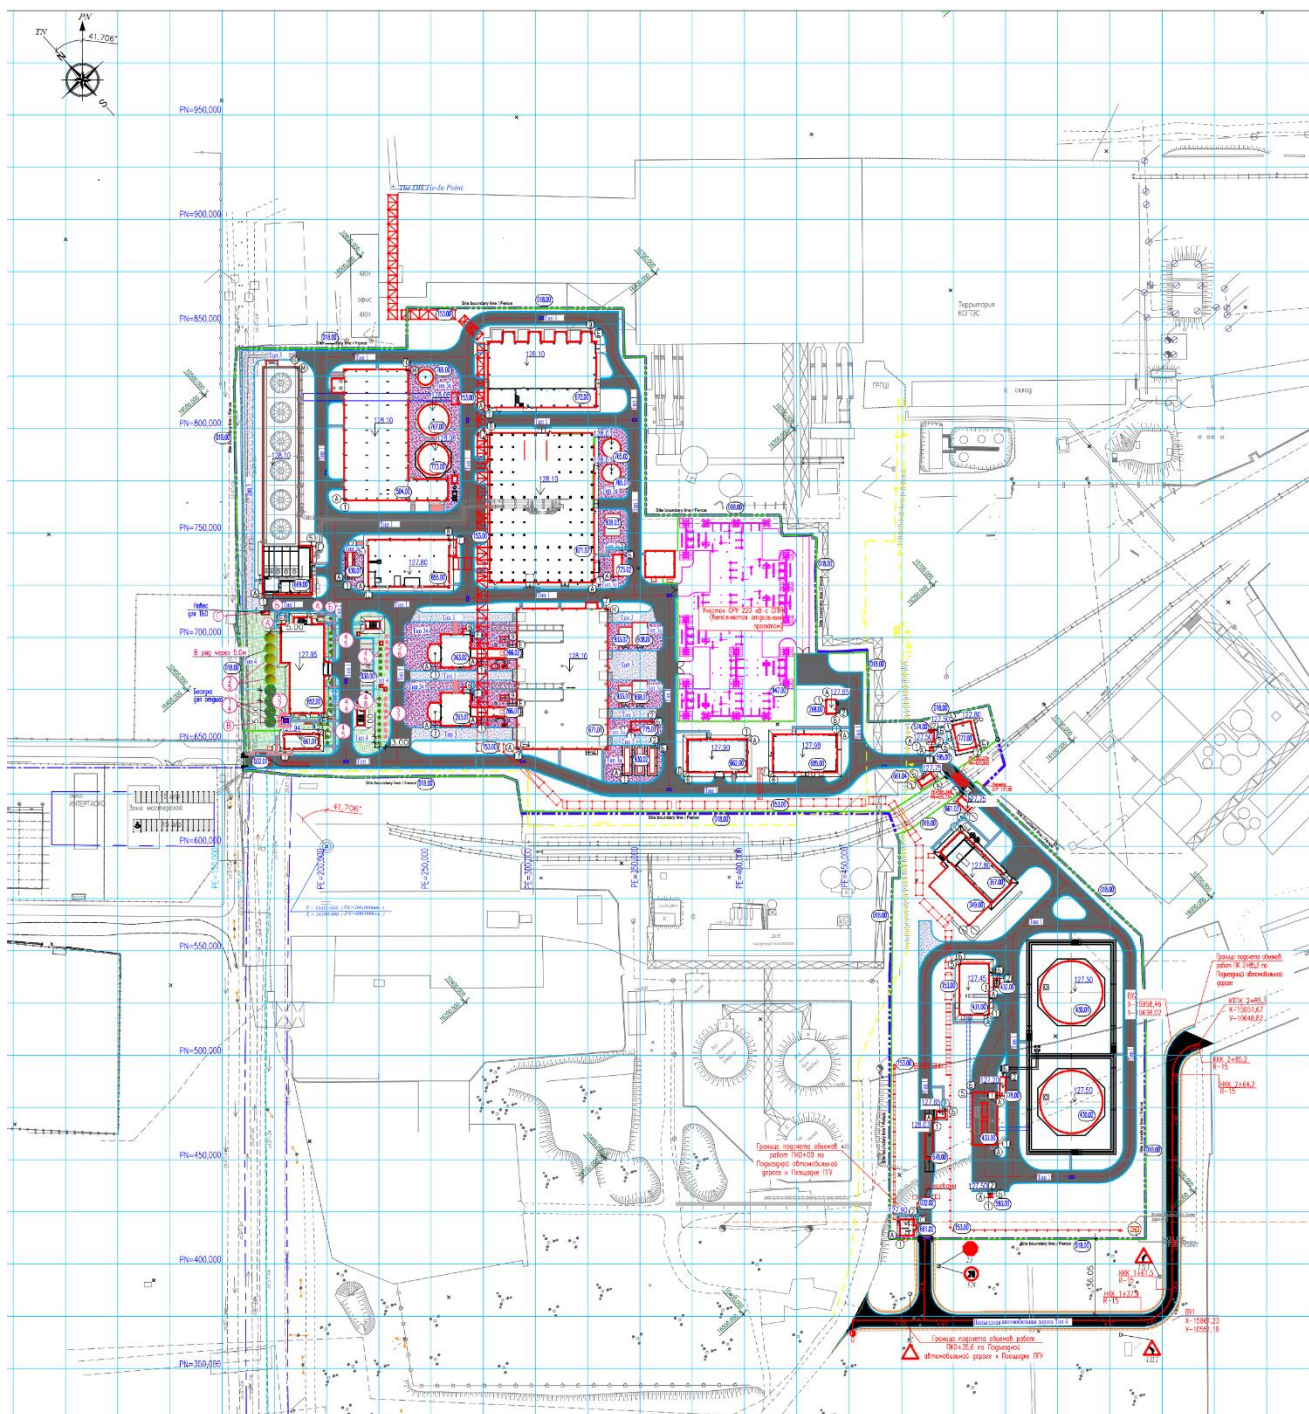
Схема генерального плана площадки ПГУ
